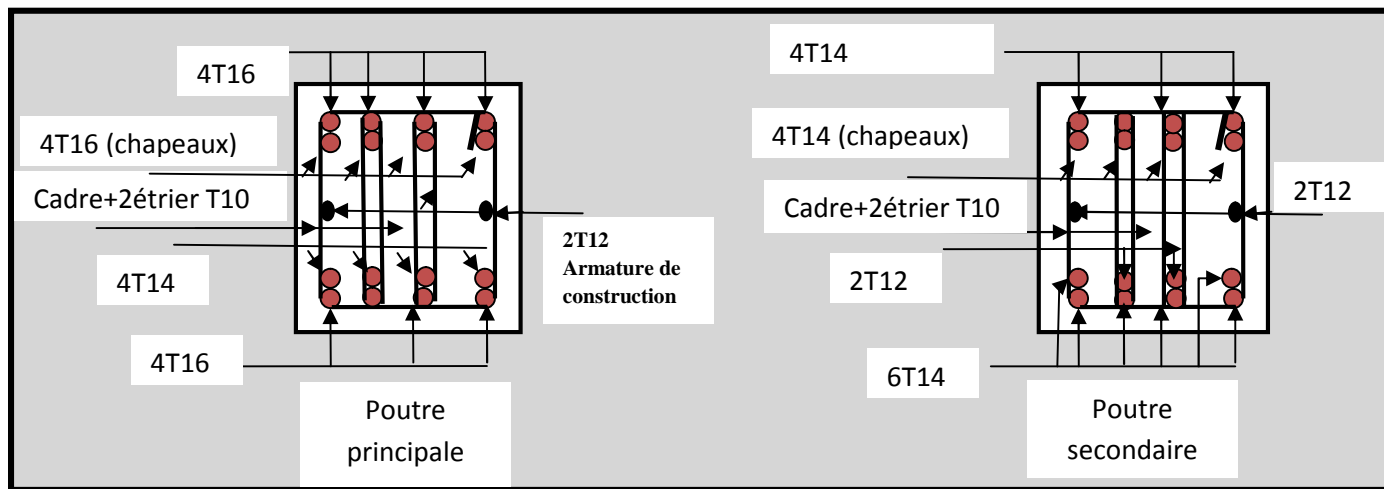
Schéma de ferrailage des poutres principales et secondaires des étages courants
